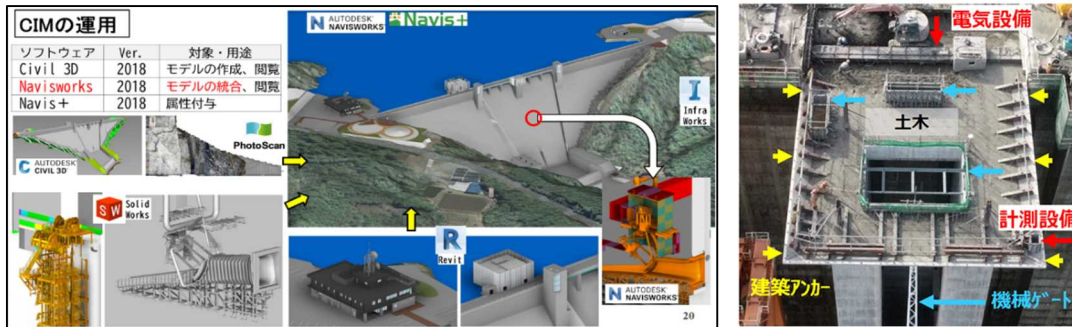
川上ダムの施工CIMの活用（左：統合したCIMの構築、右：取水塔頂部の施工）
